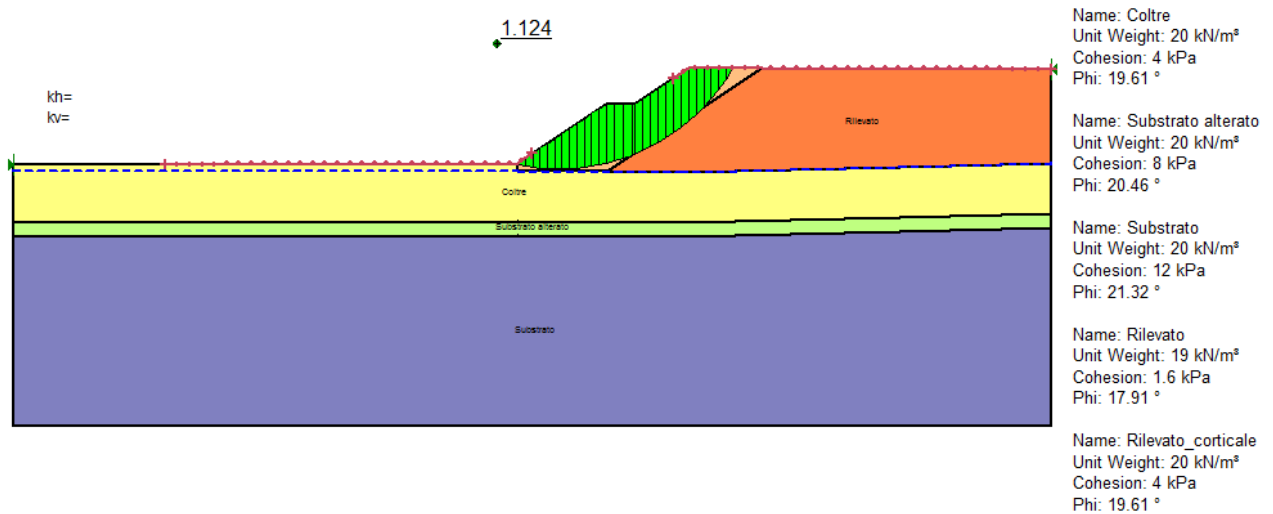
Sezione D; condizione statica. Verifica di stabilità globale.
